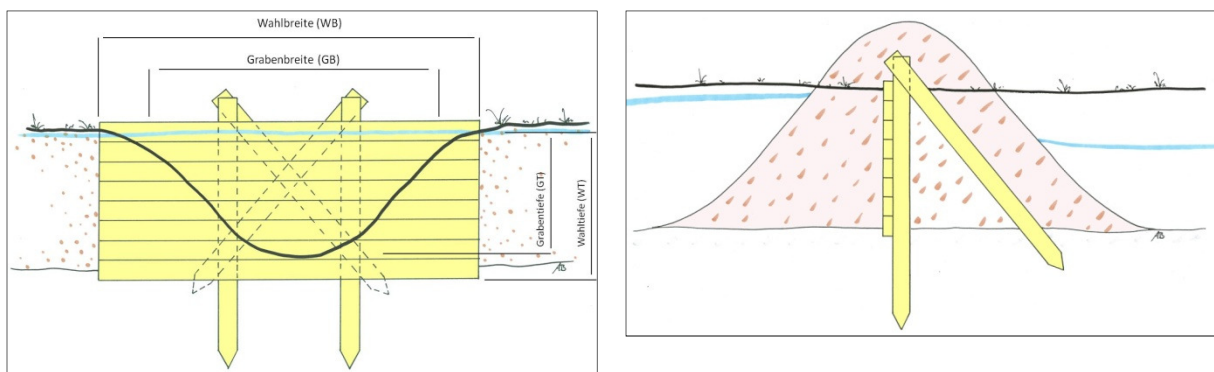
Bohlendamm (BD), Frontalansicht und Schnitt
